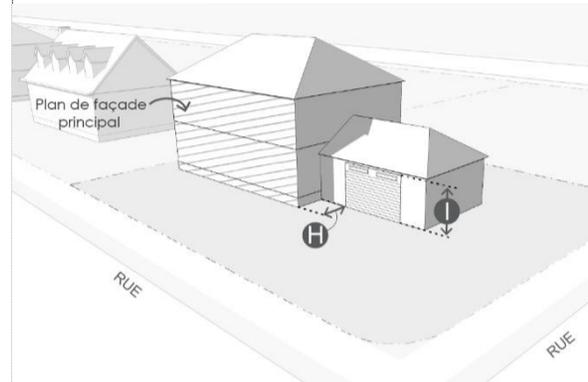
Retrait d'un garage par rapport à un plan de façade principal et hauteur d'une porte de garage
